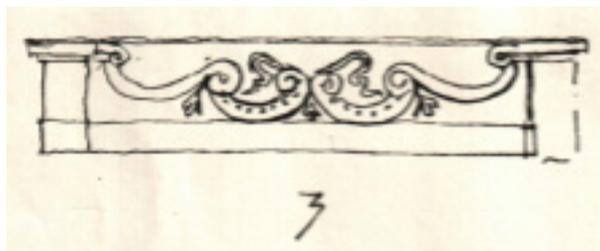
| Coroamento: 3) após modificação da cobertura. FONTE: Processo nº 1104/1994.
